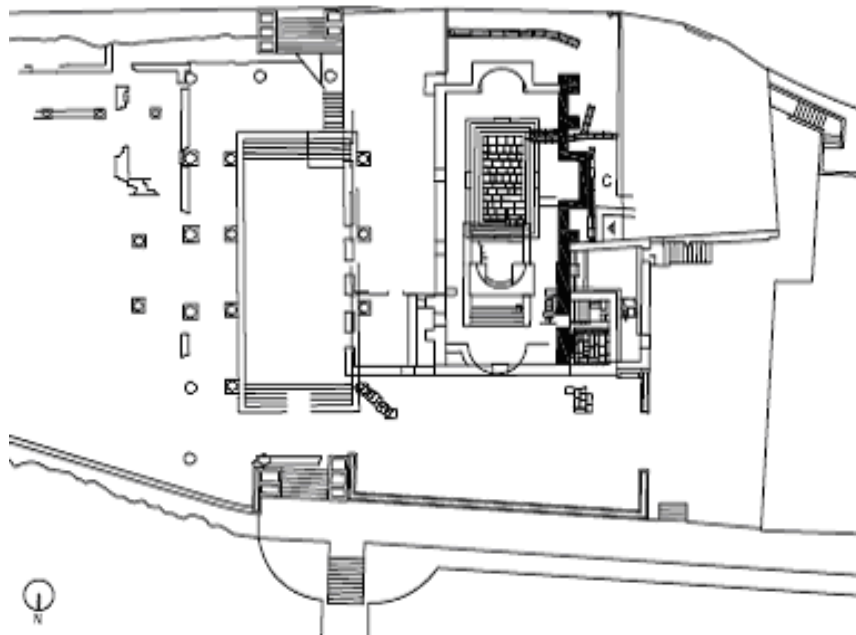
Planta e parede C , a oeste (Frade, 2000).
